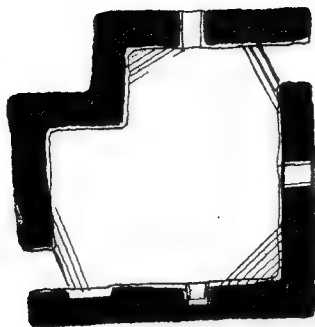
مقعد الفرازة - مخطط أفقي
